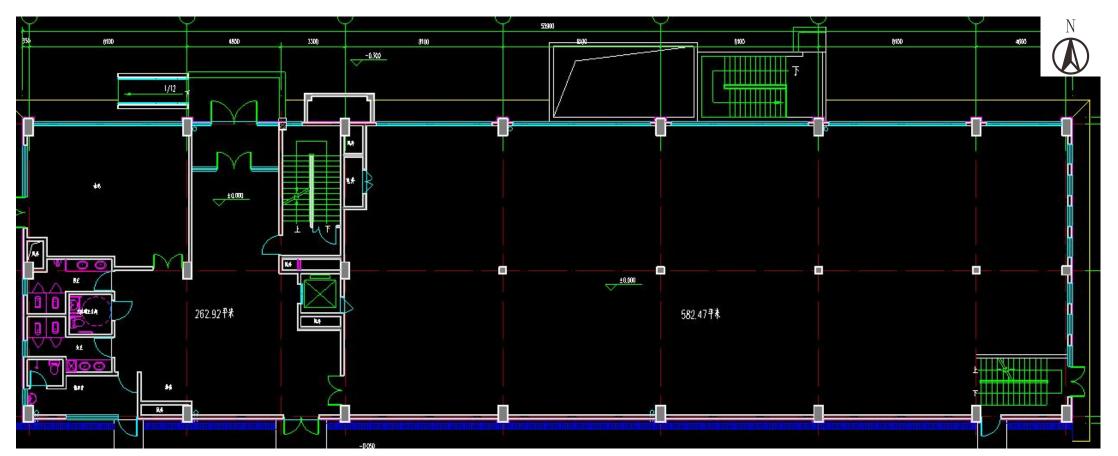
1#楼 1 层平面布置图 (1: 100)
